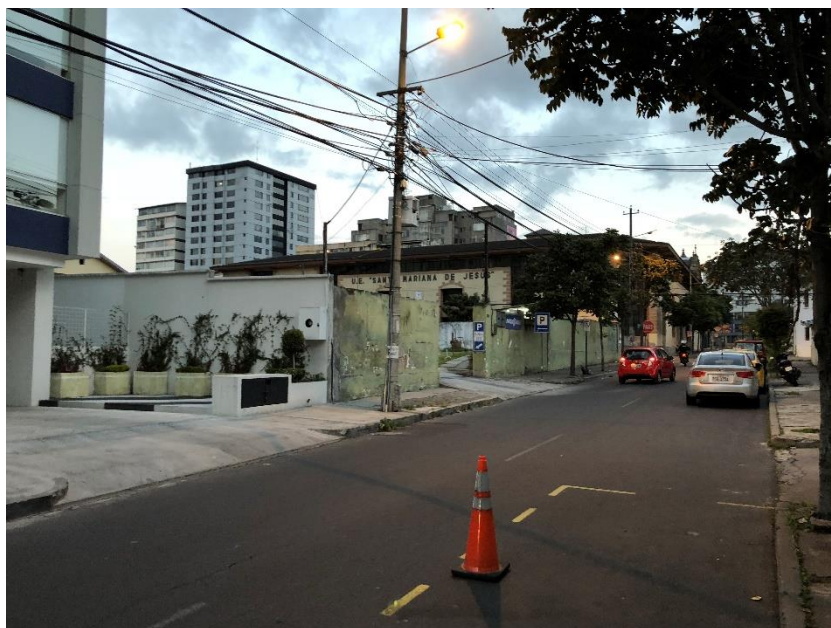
Entrada al sitio de implantación, calle Robles. Elaboración propia 2018.
